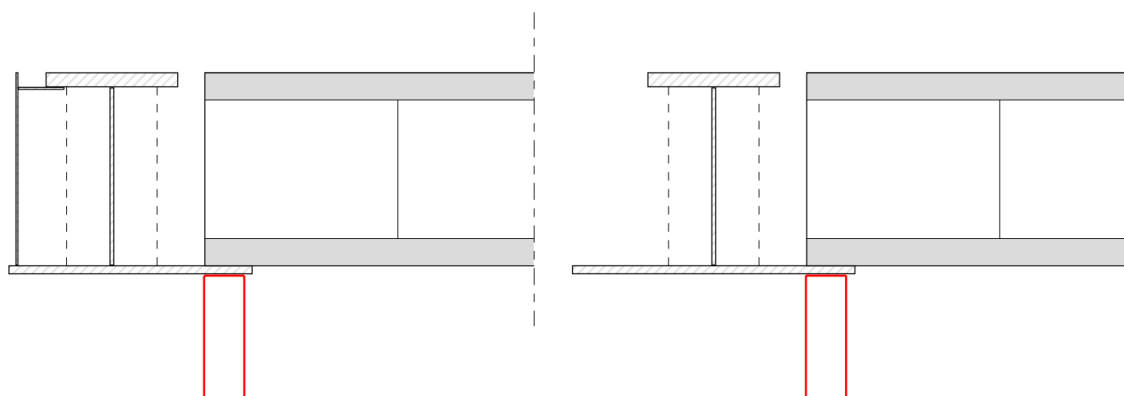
Placering af ekstra elementstøtter ved ensidig montage
